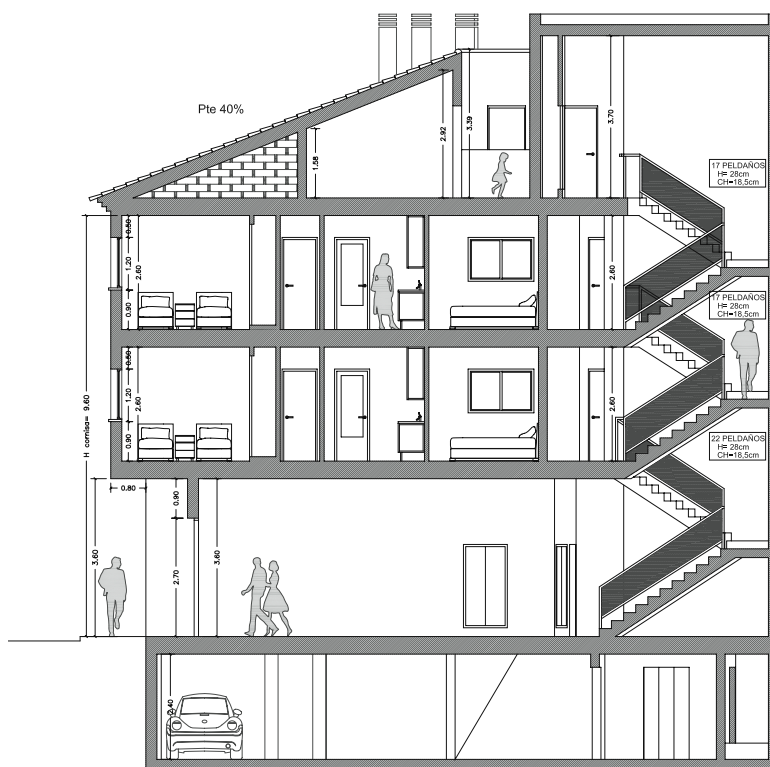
Sección transversal del edificio de 10 viviendas, locales y garaje del ejemplo.
